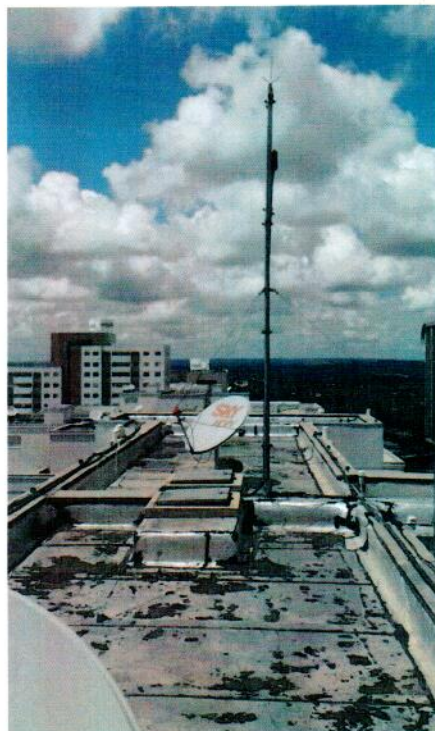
Vista da laje de cobertura em reservatório elevado (Bloco D)
